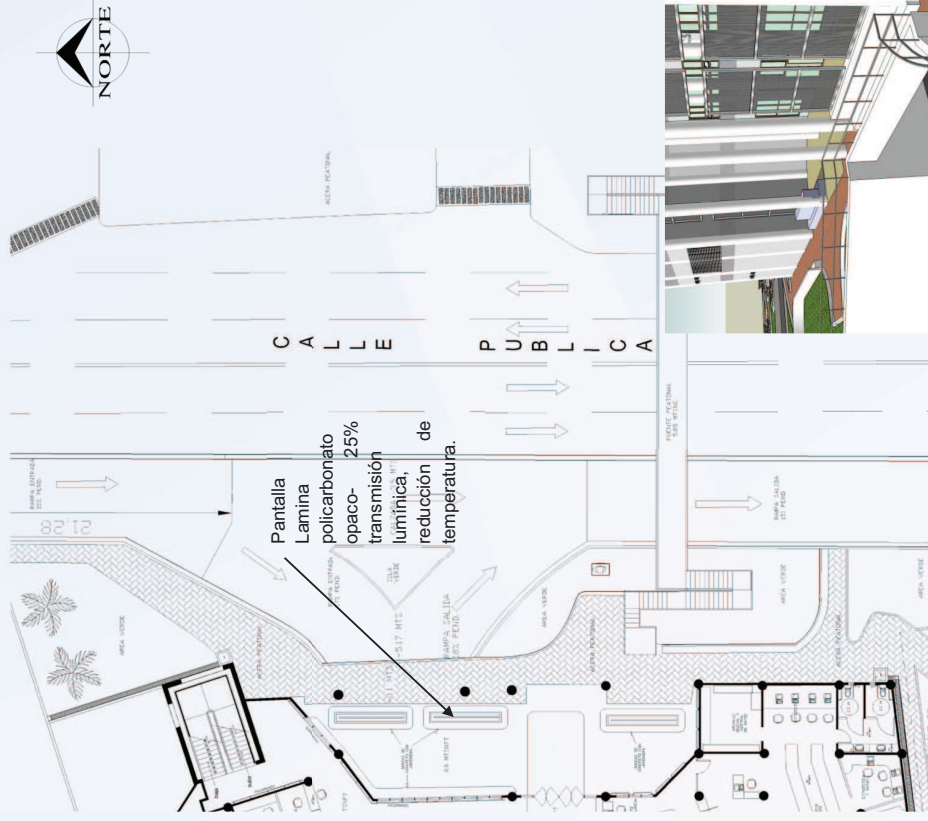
Tratamiento de Ingreso Principal. Esc.: 1:250.
